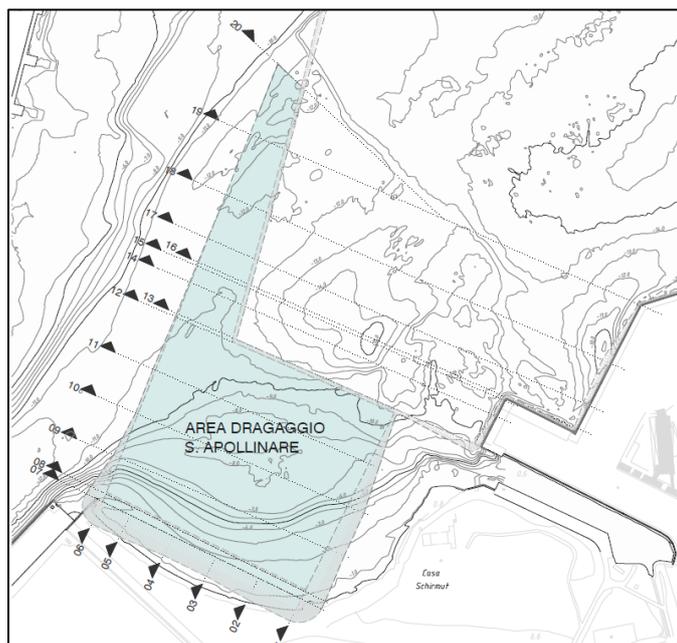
Planimetria di dragaggio Area S. Apollinare
